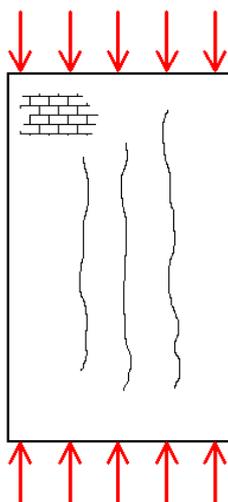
Configuração típica de fissuras causadas por sobrecarga (MAGALHÃES, 2004)
